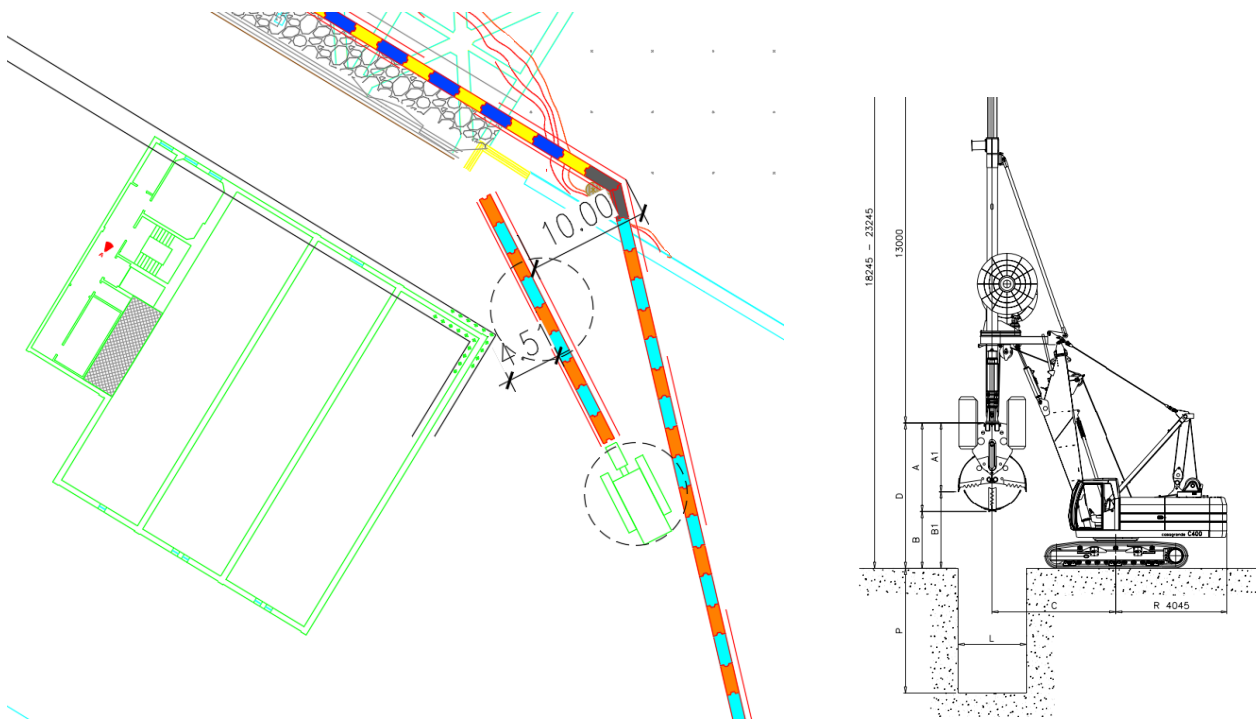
Planimetria con arretramento sponda, ATF 2025 Molo Sali.
